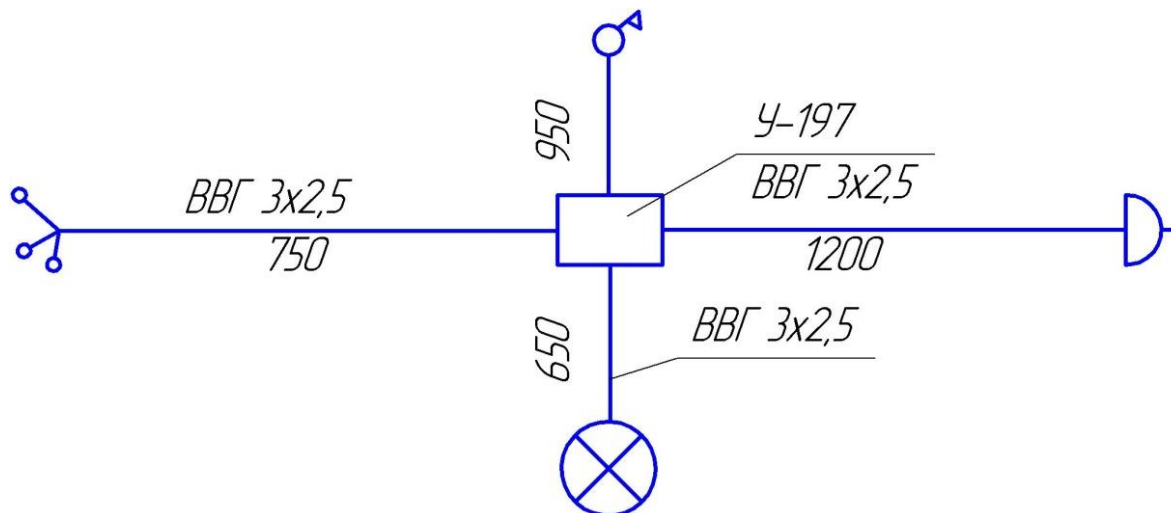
Эскиз замеров электропроводки проводами и кабелями
